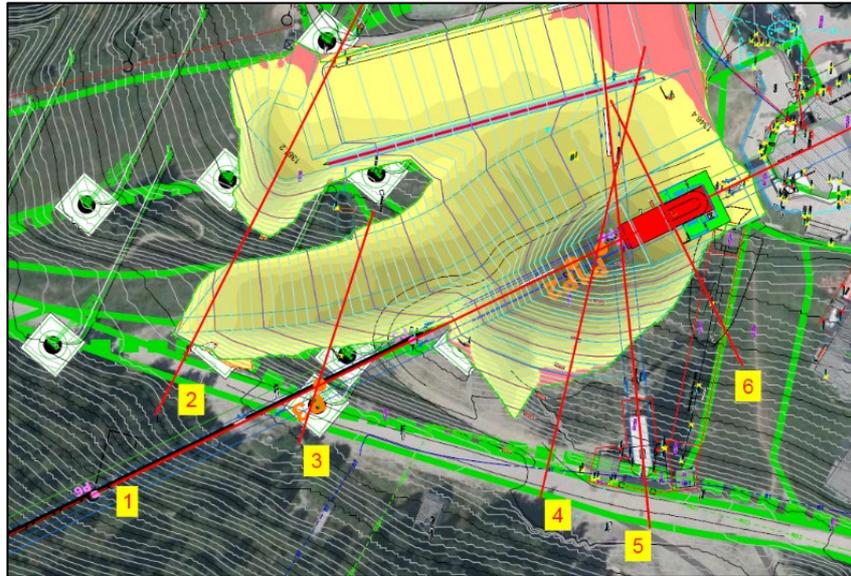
Extrait du plan de terrassement G1 - 27/11/2024
